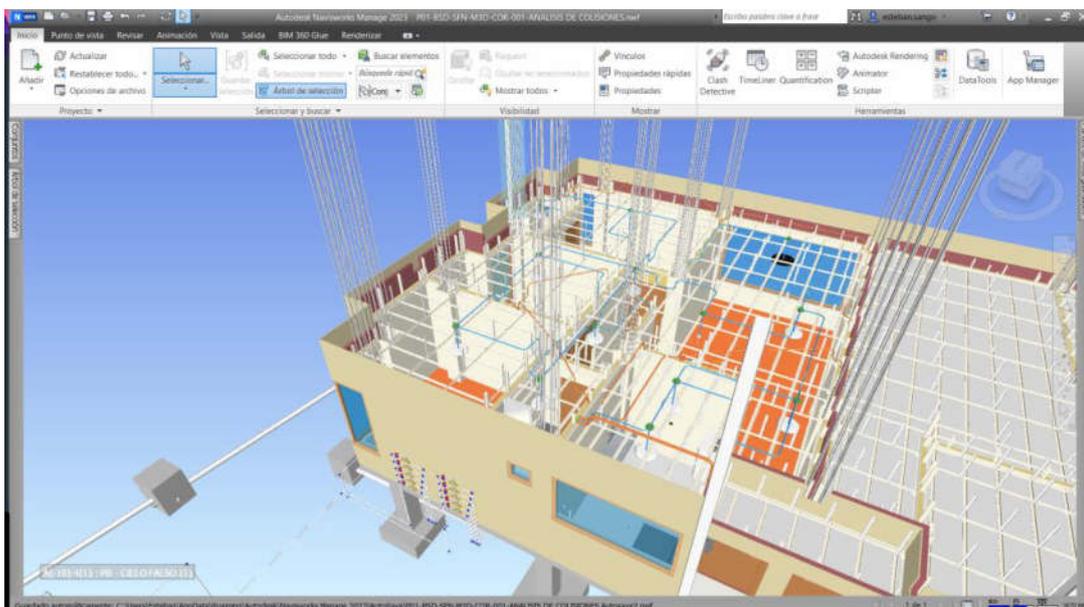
Apartamento tipo en modelo federado Central en Navisworks
